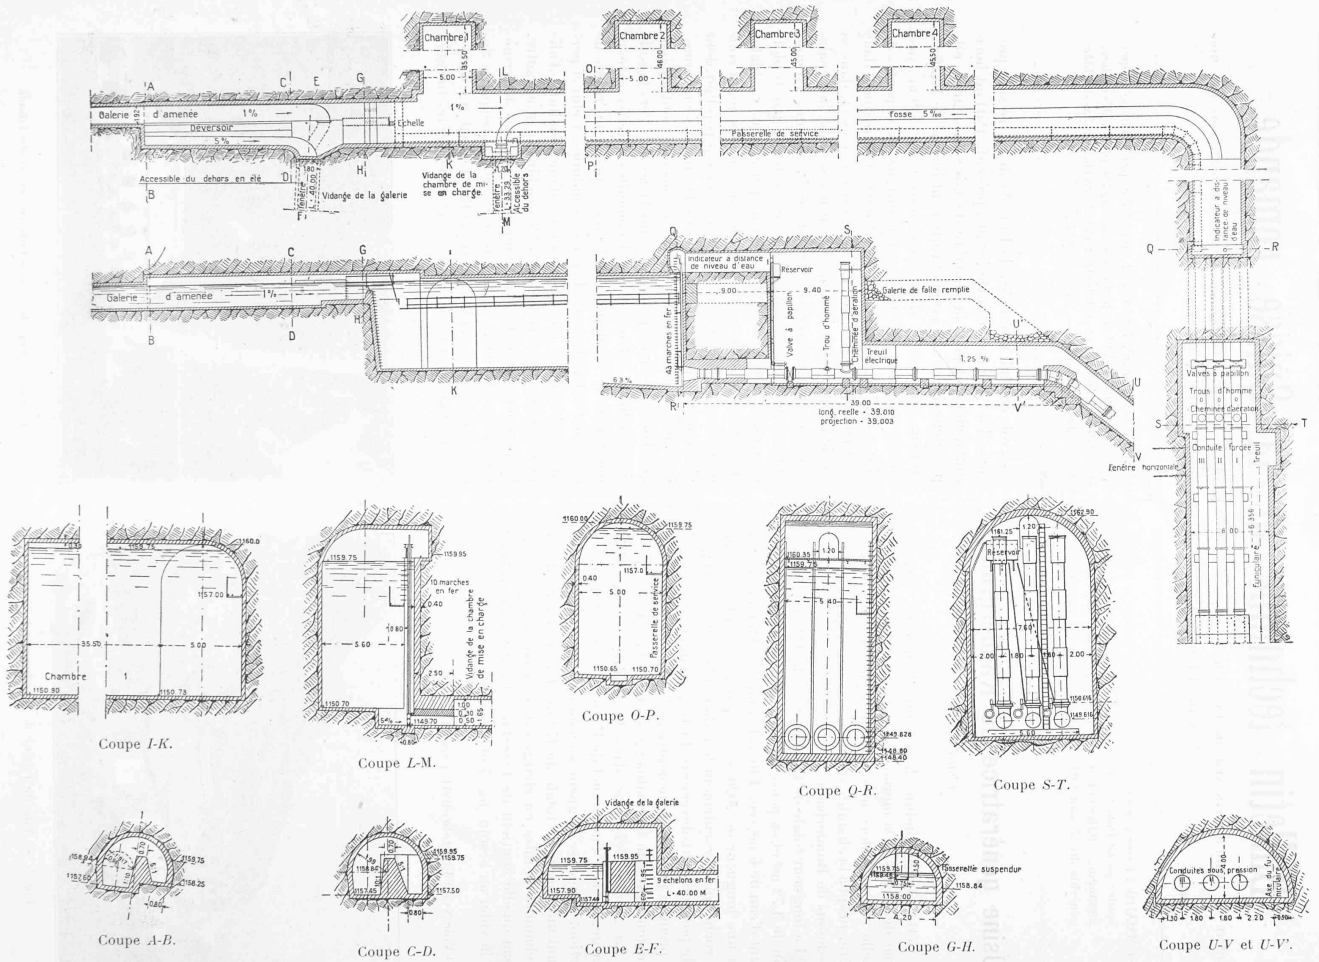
Plan et coupe en long de la galerie d'aménée. — 1 : 500. — Coupes transversales — 1 : 300
